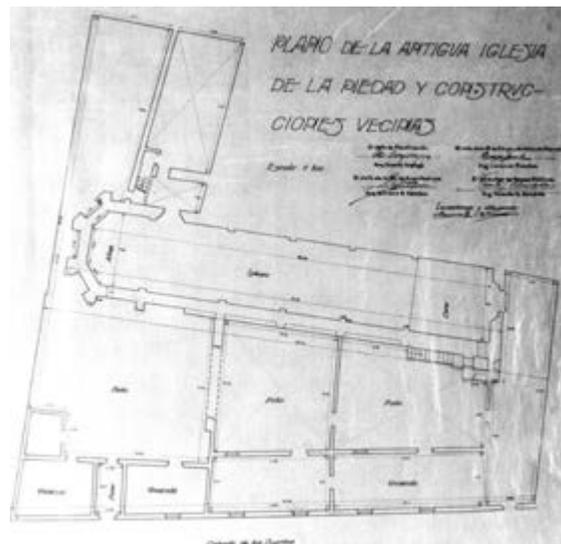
Plano de la antigua iglesia de la Piedad y construcciones vecinas. Levantamiento y dibujo Carlos Lezna y Carlos Franco (Archivo Histórico de la Ciudad de México “Carlos de Sigüenza y Góngora”. Planoteca. Módulo 2, planero 2, fajilla 86, s/f. Foto de Alfonso Medina Guerra).
